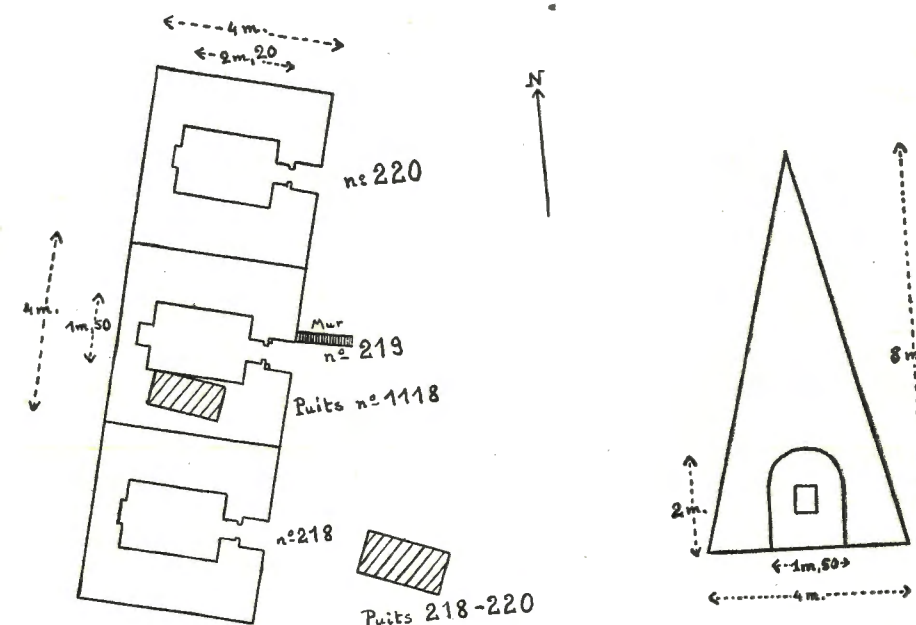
Plan des chapelles n°s 218-219-220⁽¹⁾.
